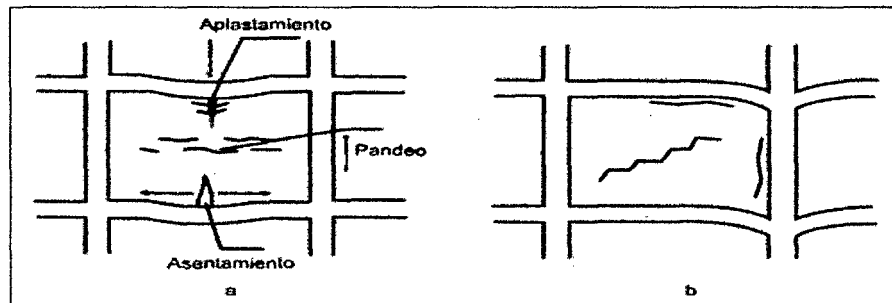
32. Cargas uniformes flecha en vigas y losas. Fuente: (Cámara , 2010).
